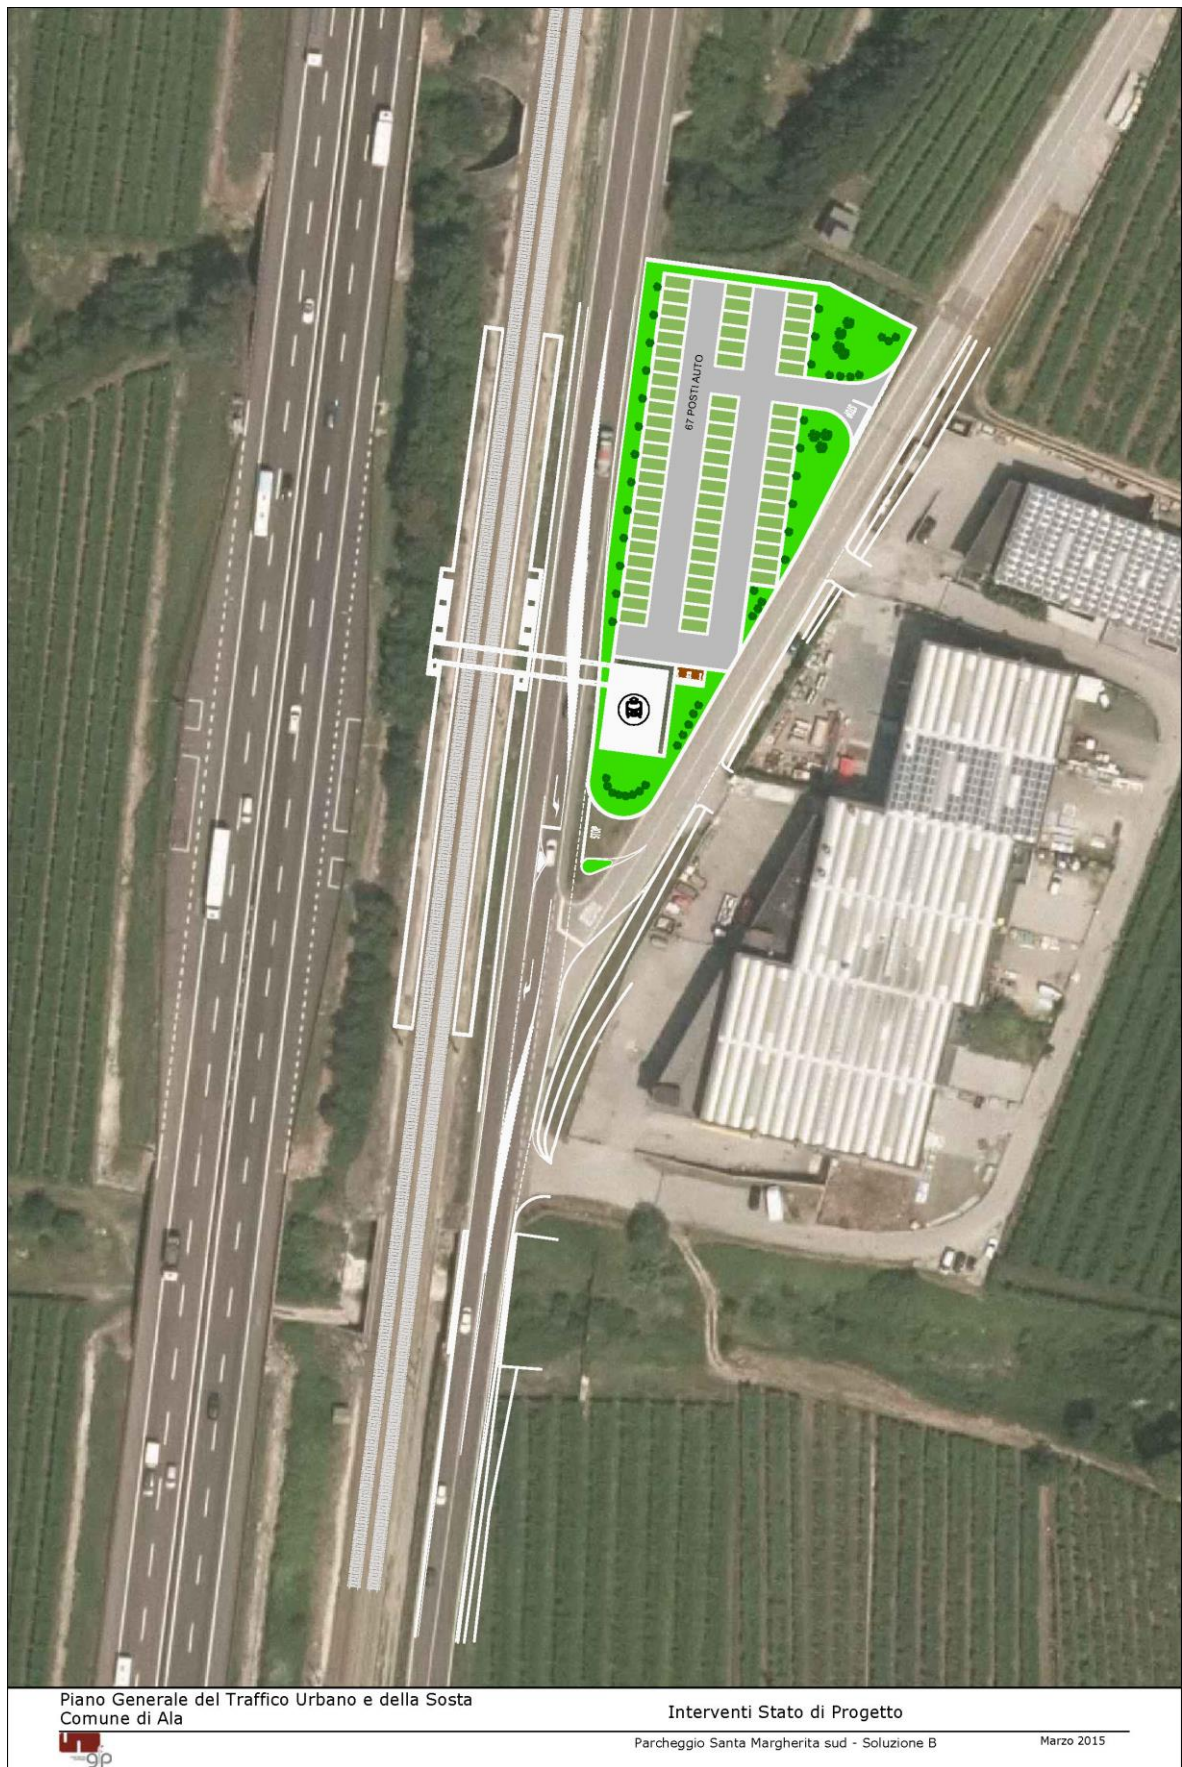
Interventi Stato di Progetto – Lungo Termine – Parcheggio fermata Località S. Margherita Sud - Soluzione B
